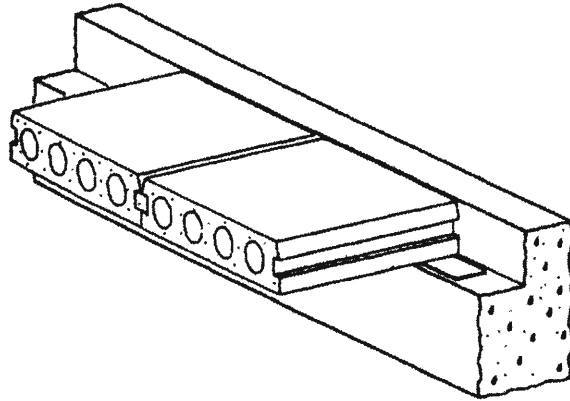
Conexión típica losa - viga. (Ref. 33)
